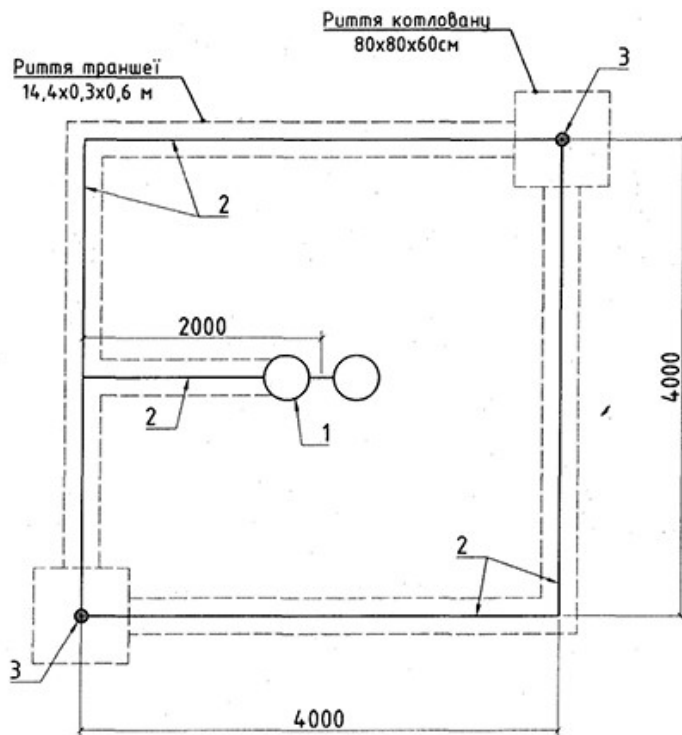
Штучний заземлюючий пристрій для опори без обладнання. Вид зверху.
